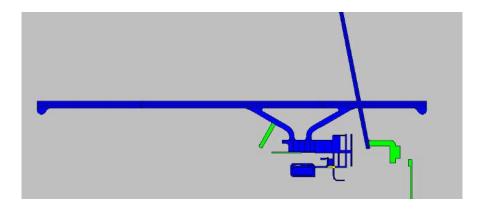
Plano de pavimentos acorde al tipo de pavimento en SLP
